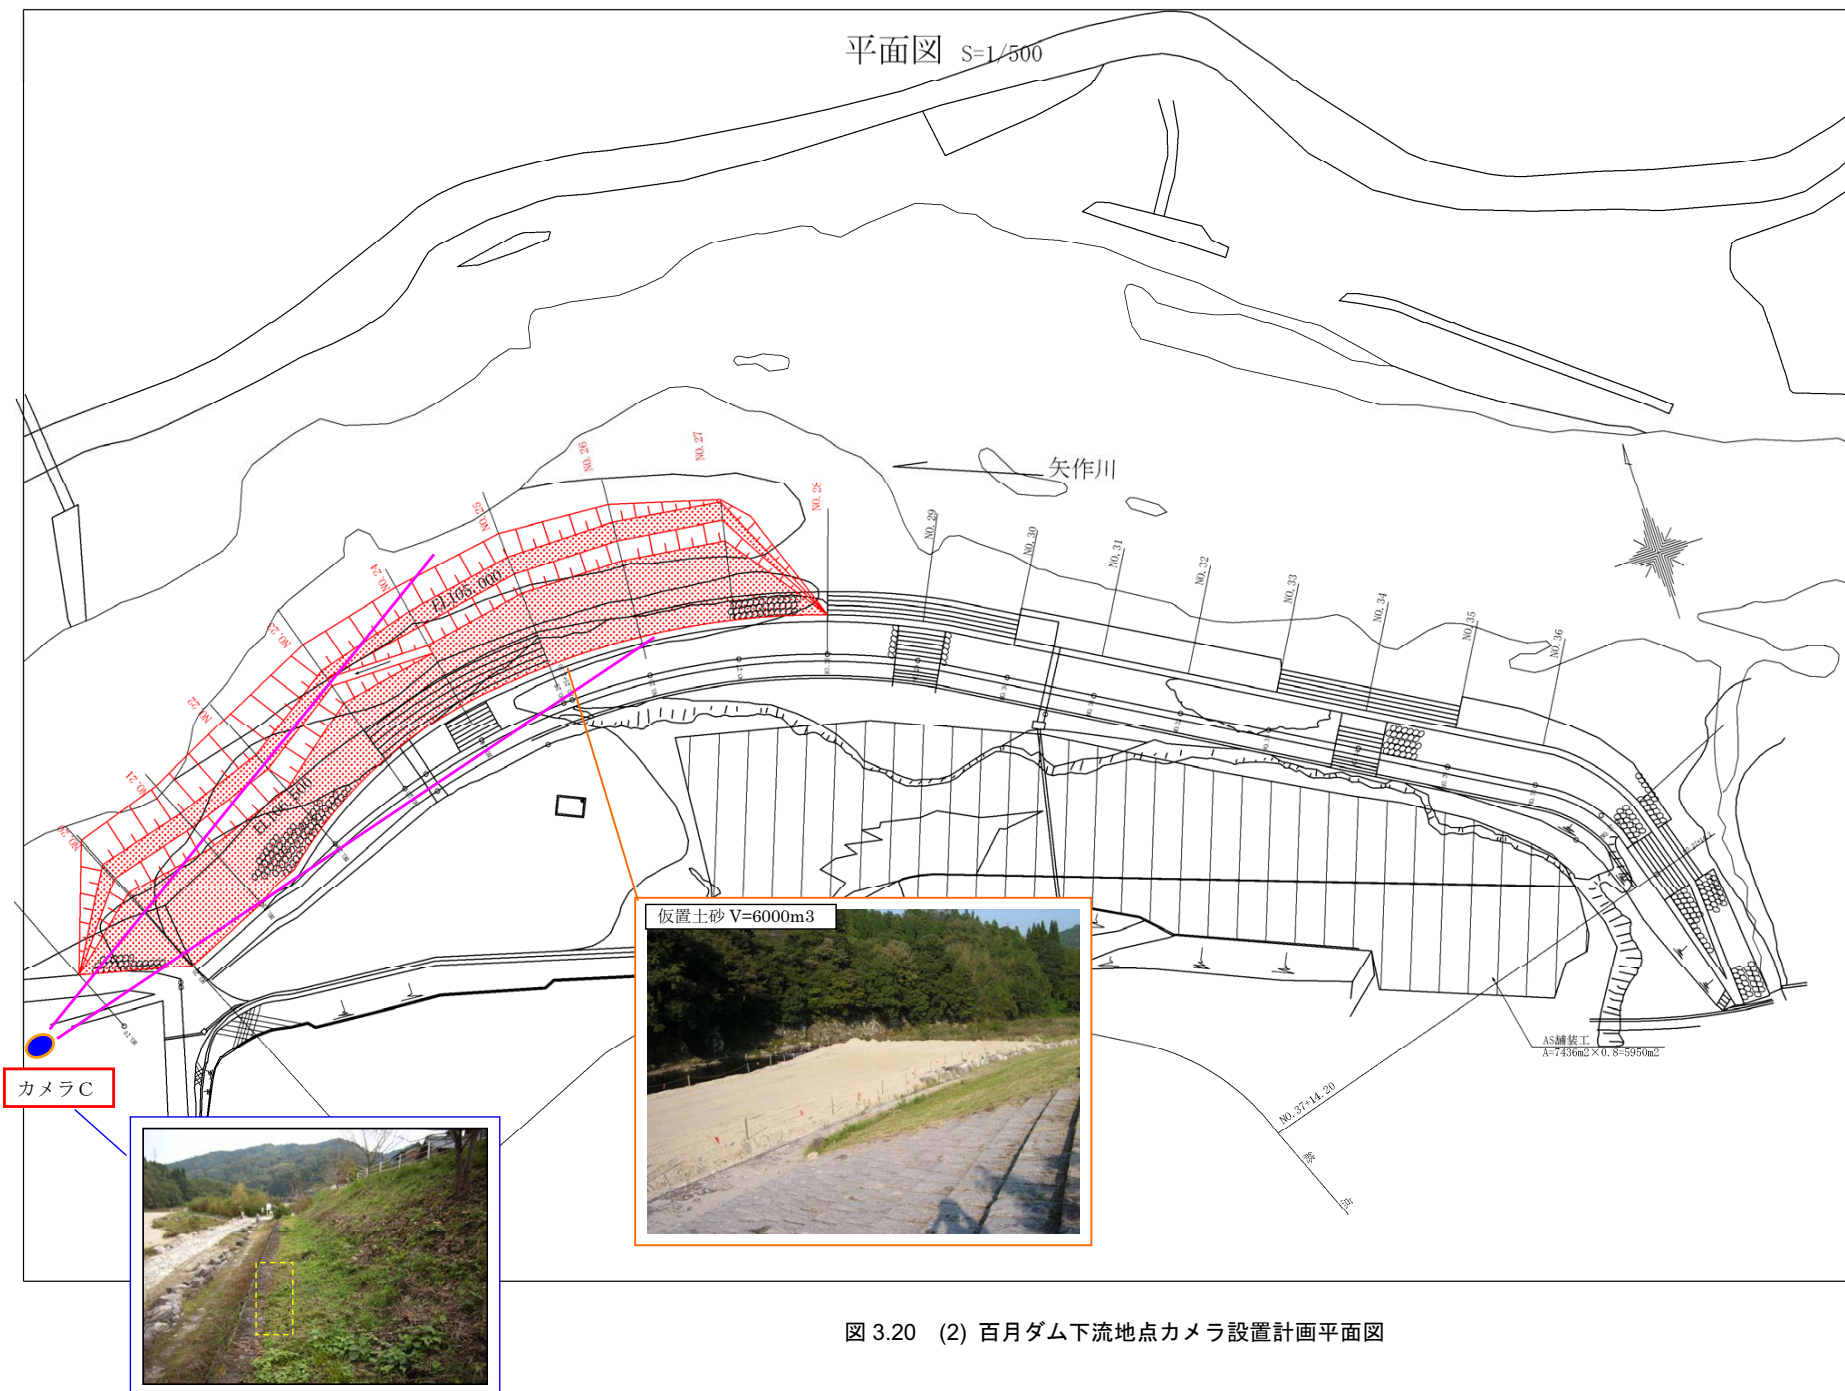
(2) 百月ダム下流地点カメラ設置計画平面図
